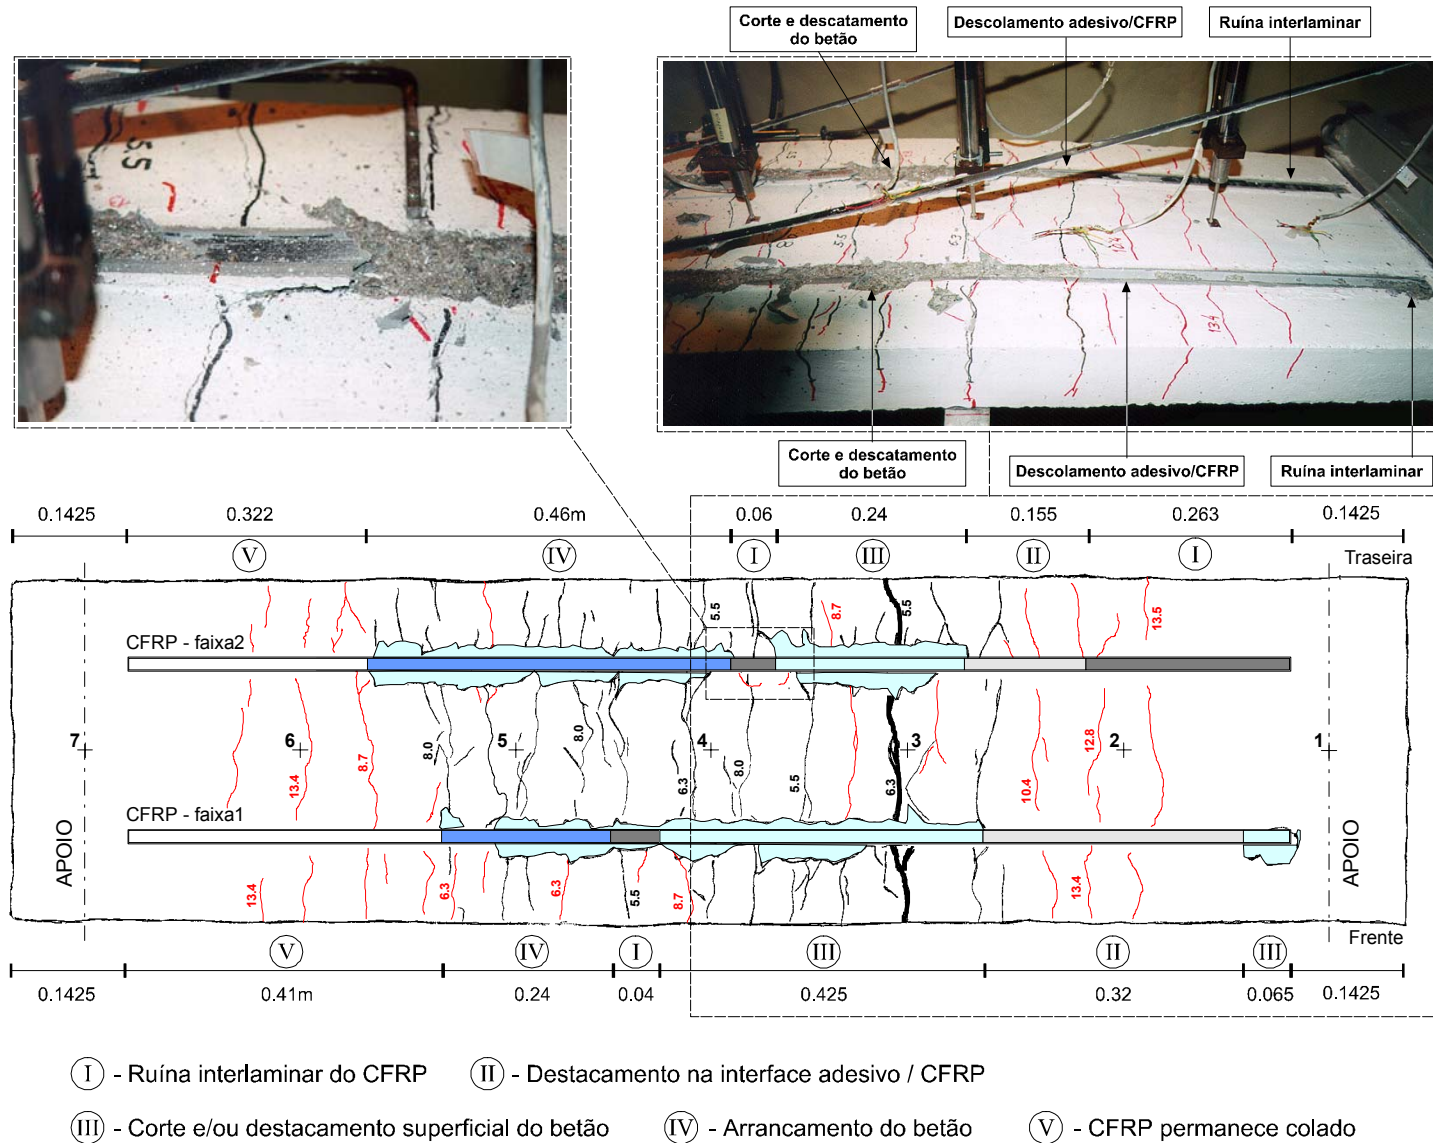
Ruína do laminado de CFRP na laje LCIS (planta e pormenores).
